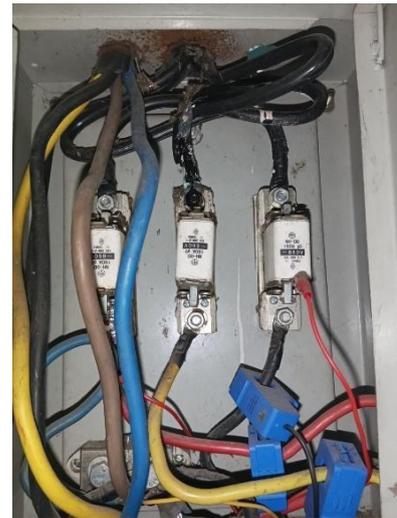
Panel Penerangan dan Stop Kontak Lantai 1 Gedung B Fakultas Teknik Universitas Lampung
